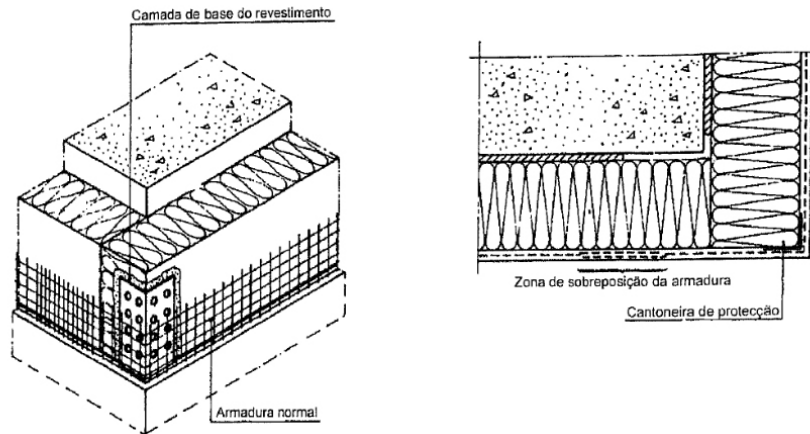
Solução de aresta de um edifício, com reforço através da aplicação de uma cantoneira e da sobreposição da rede de fibra de vidro. (SILVA, 2013)
